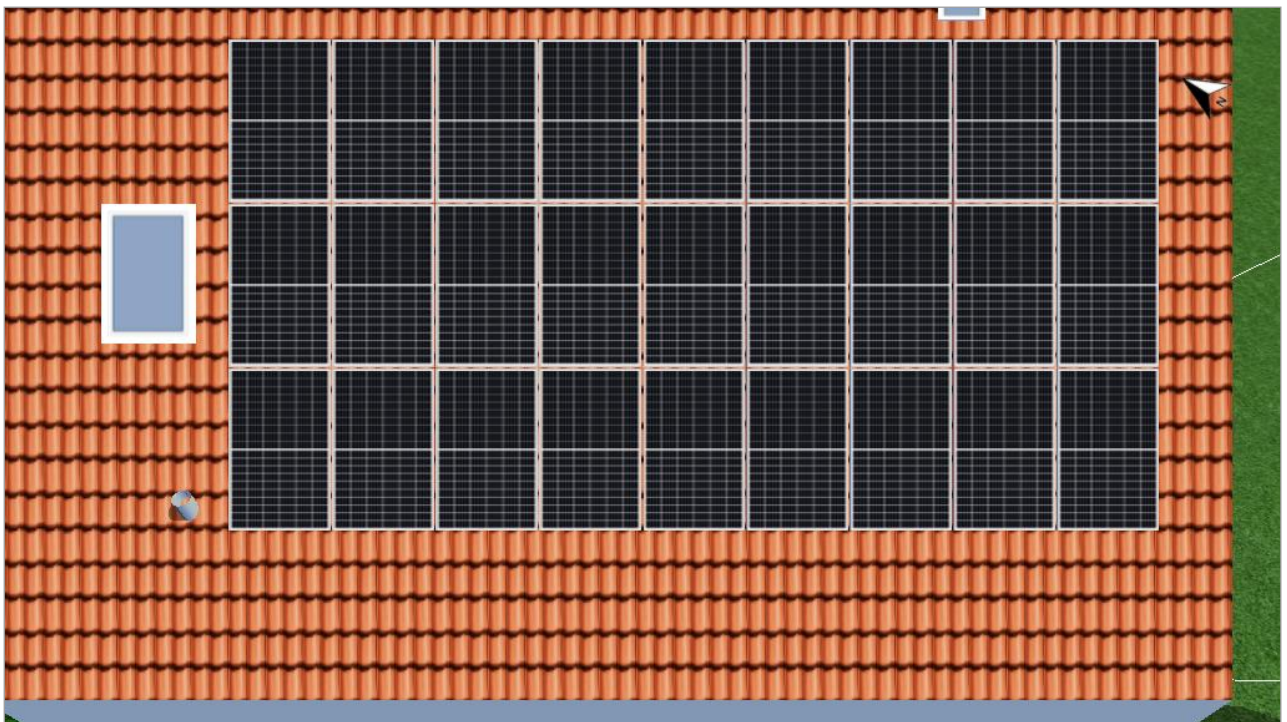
Modulfläche - Gebäude 01-Dachfläche Südwest
